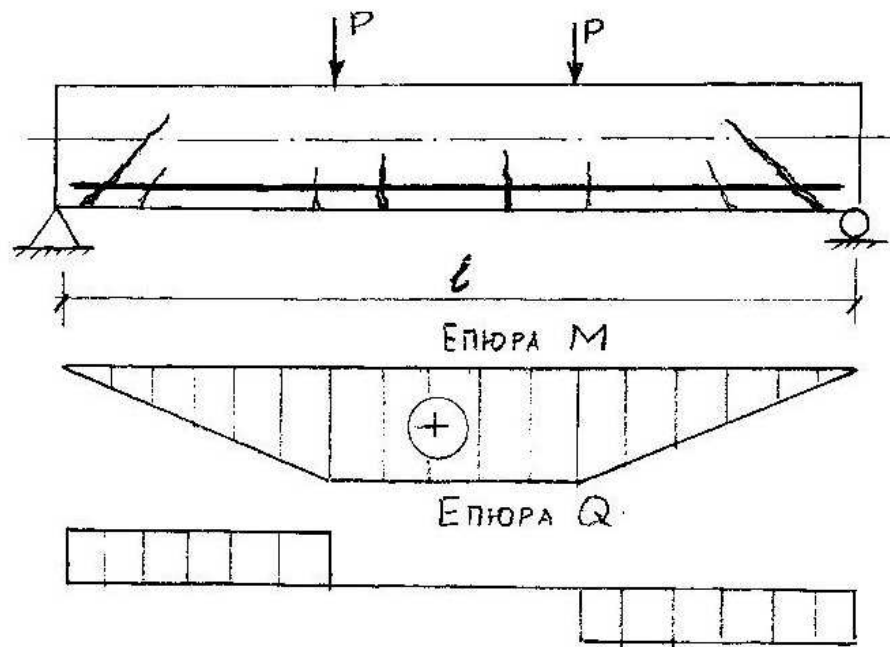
Епюри зусиль M і Q . Можливі форми руйнування балки за нормальними чи похилими перерізами
